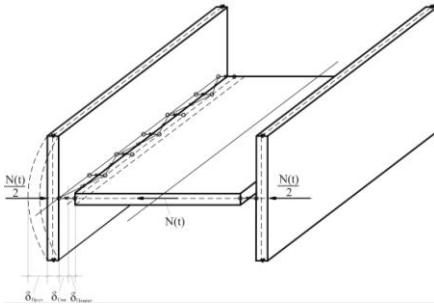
Расчетная схема продольных стен и междуэтажных перекрытий
